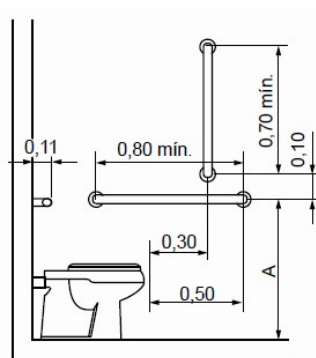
Vista lateral - Instalação de barras horizontais e verticais.
